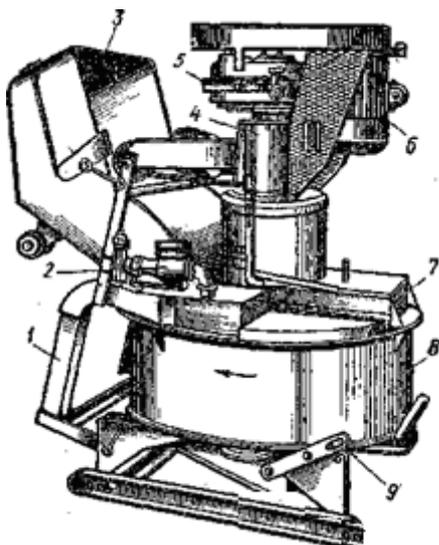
Бетоносмеситель СБ-80: 1 — направляющая ковша подъемника, 2 — дозатор воды, 3 — ковш скипового подъемника, 4 — лебедка скипового подъемника, 5 — редуктор, 6 — электродвигатель, 7 — рама, 8 — чаша, 9 — рукоятка затвора.
